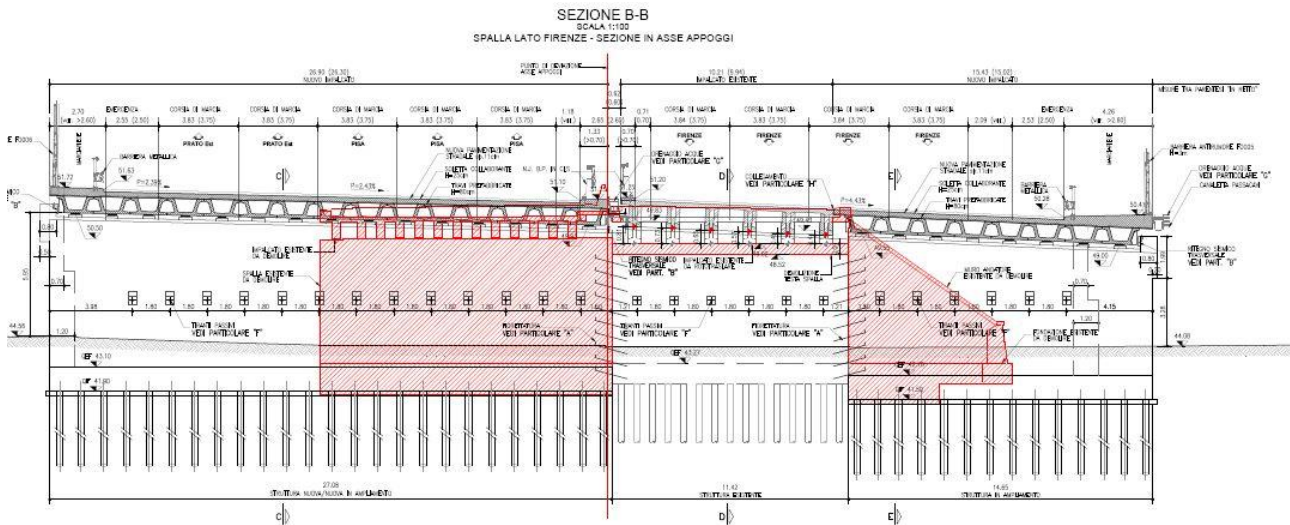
Sezioni tipo progetto ampliamento sottovia.
